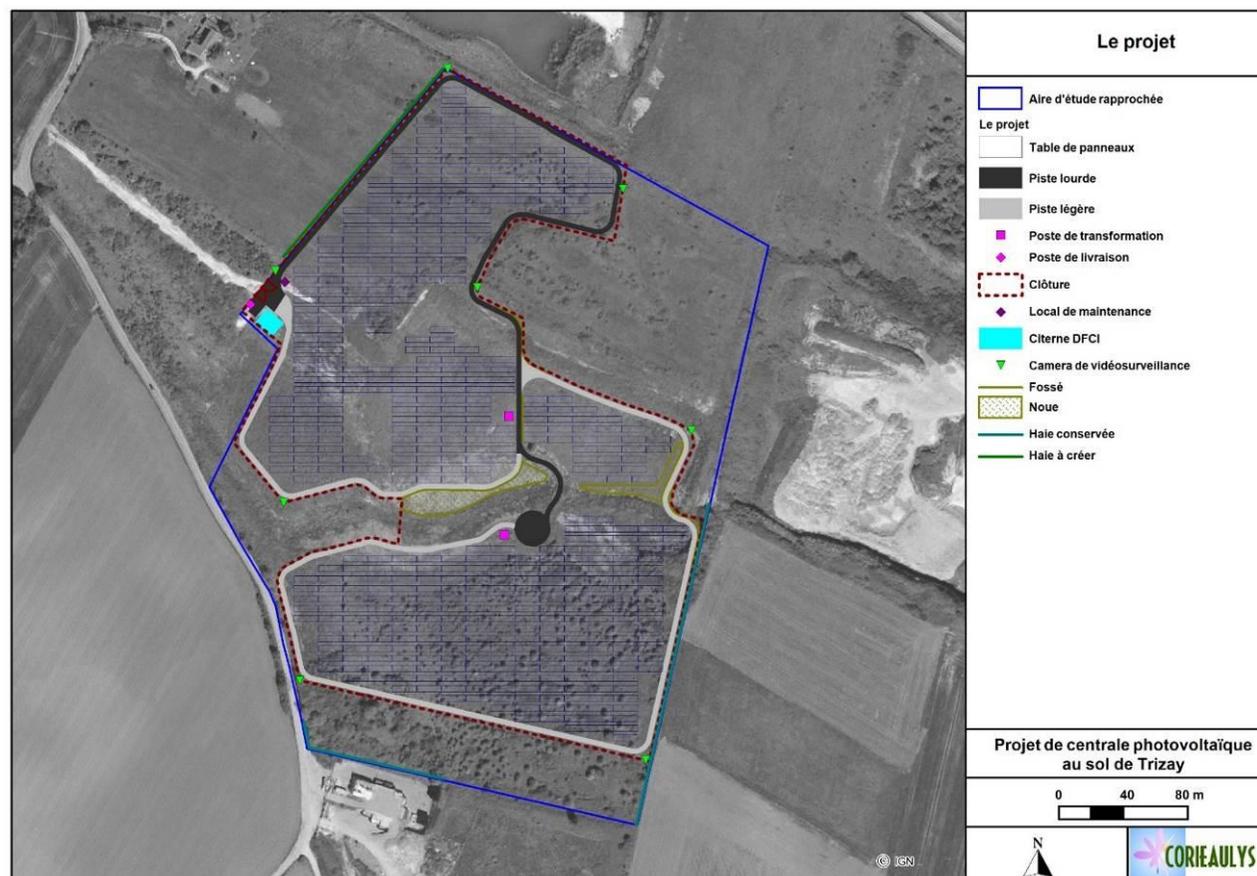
Plan de masse de la variante retenue (Source Urb asolar)
